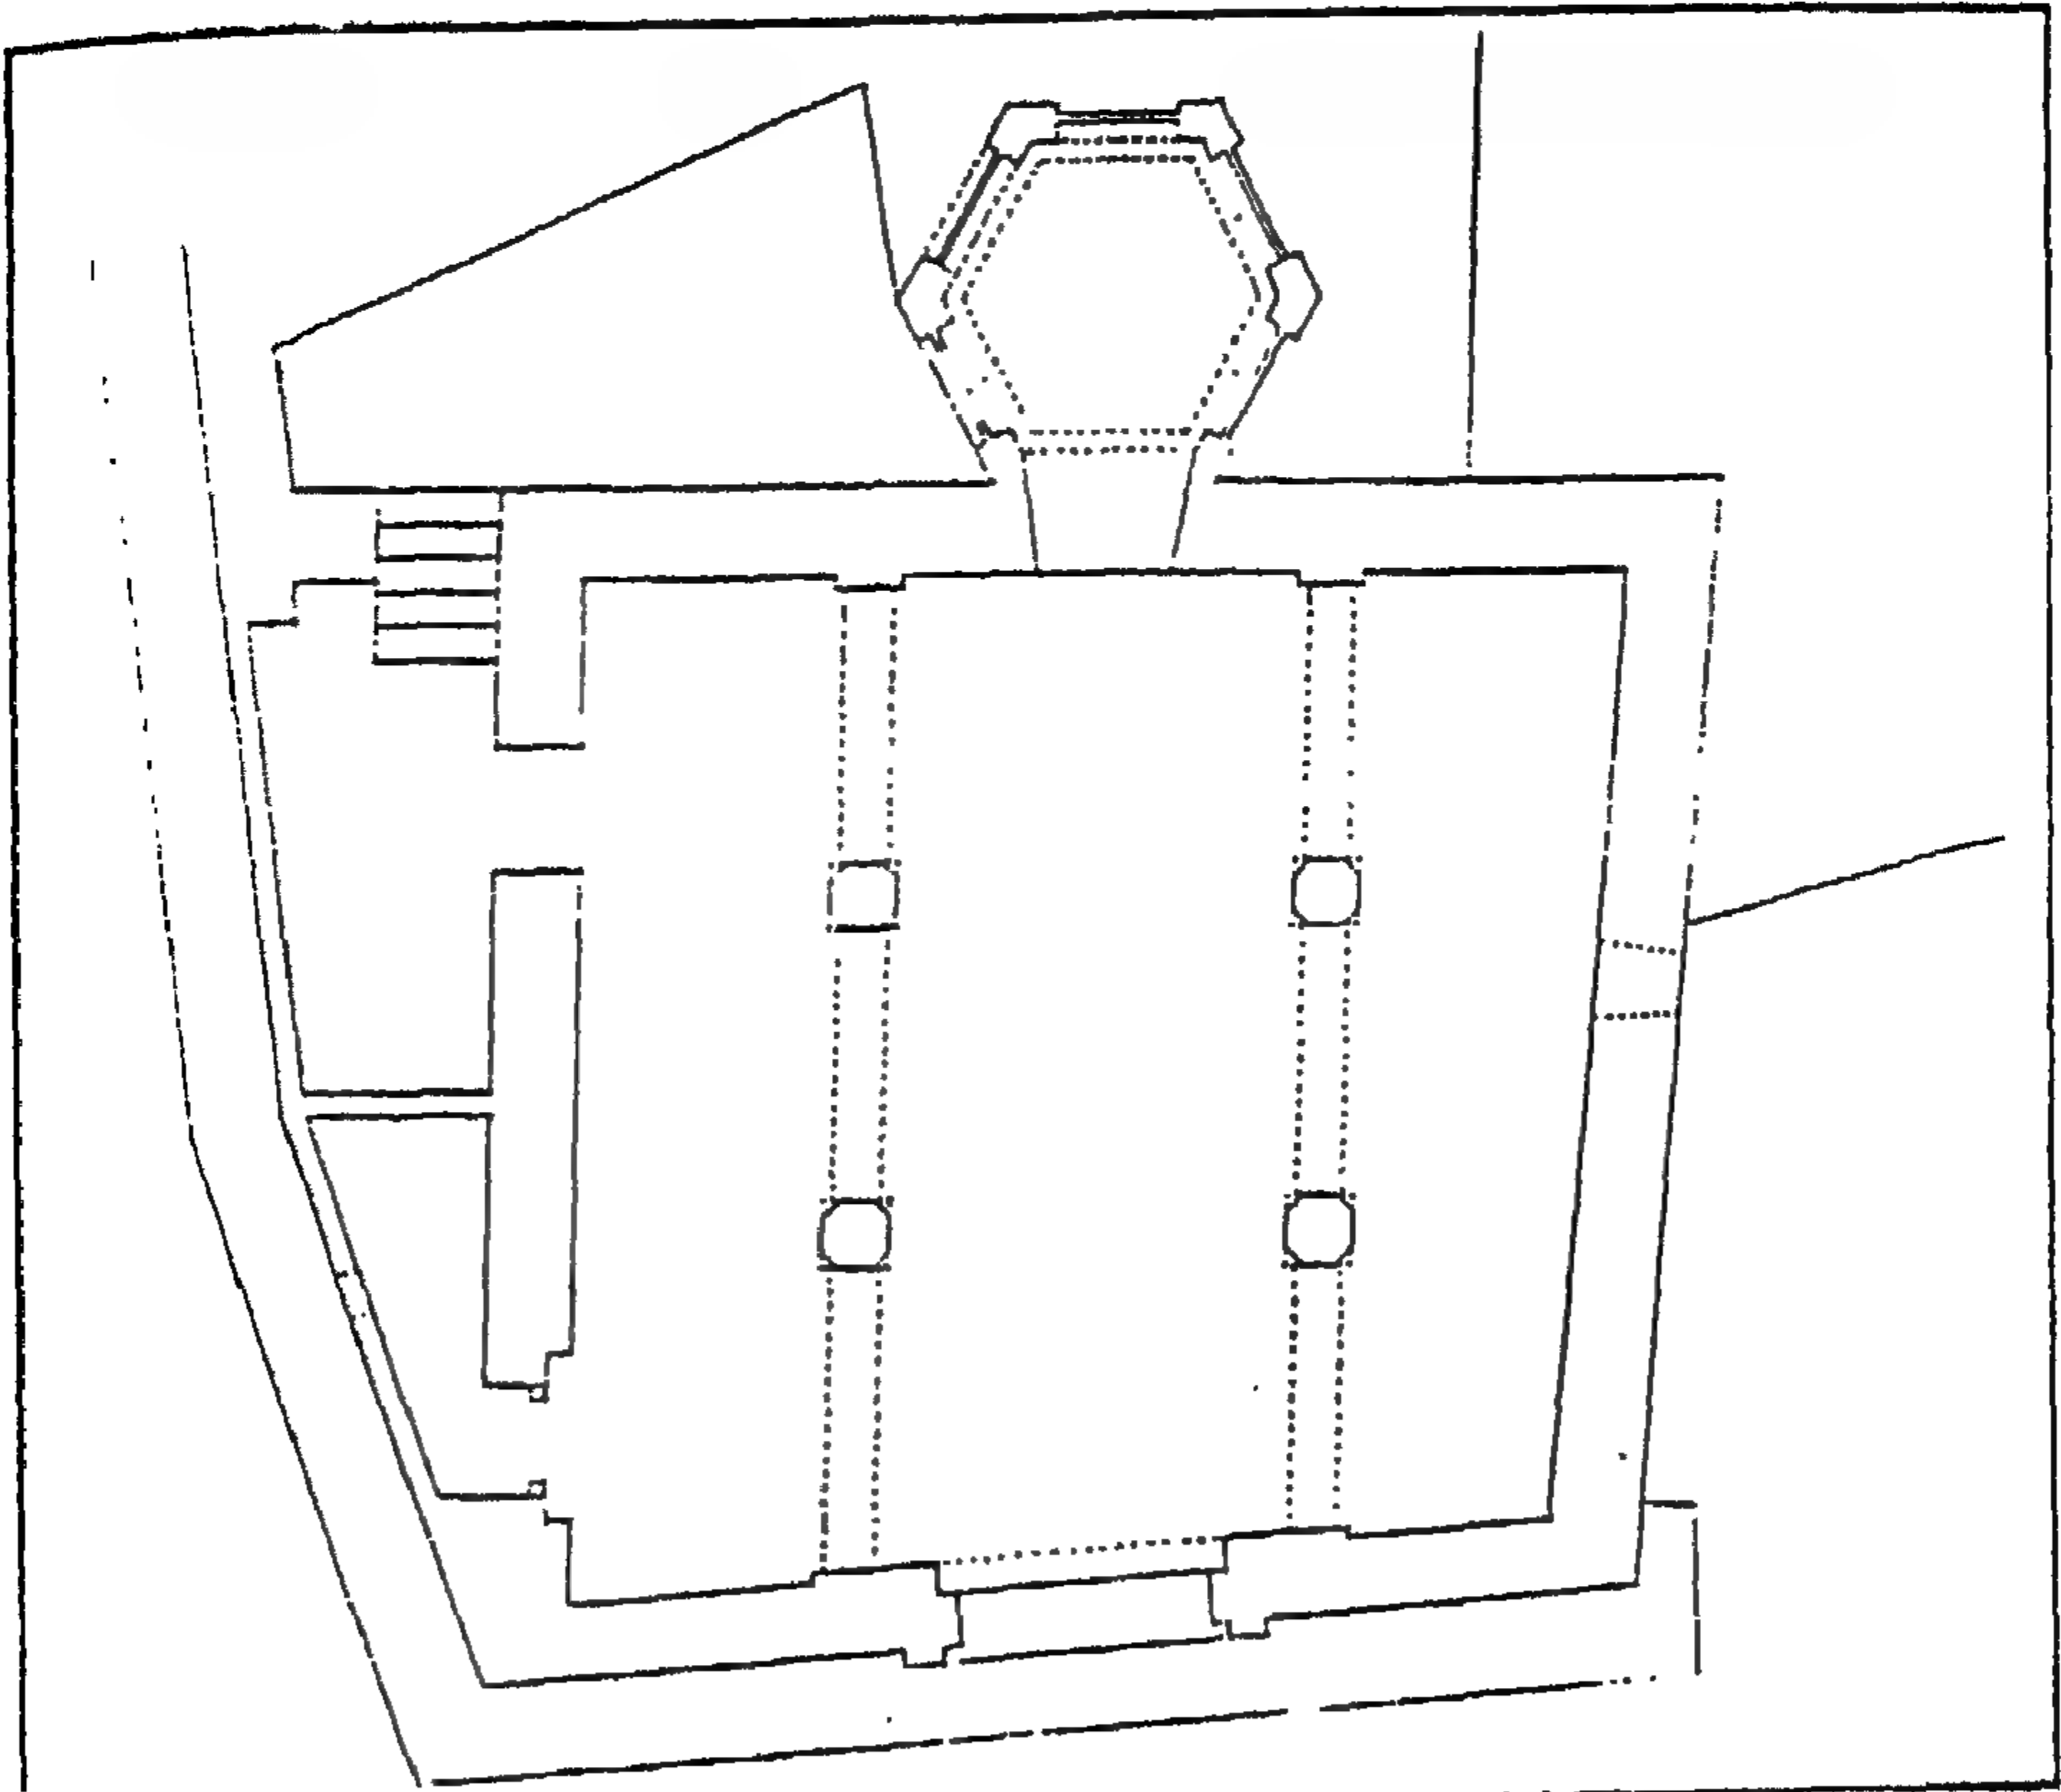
مسقط أفقي لمسجد بوفتاته في سوسة بتونس . (عن : Creswell) .
